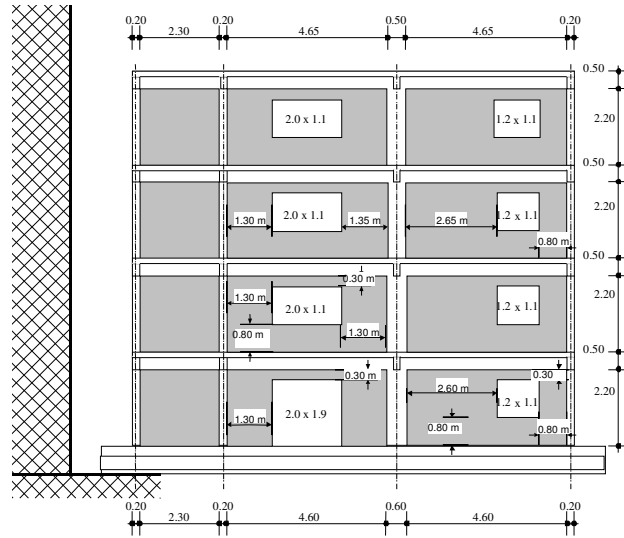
Pórtico preenchido com painéis de alvenaria: vista geral (dimensões em metros)
